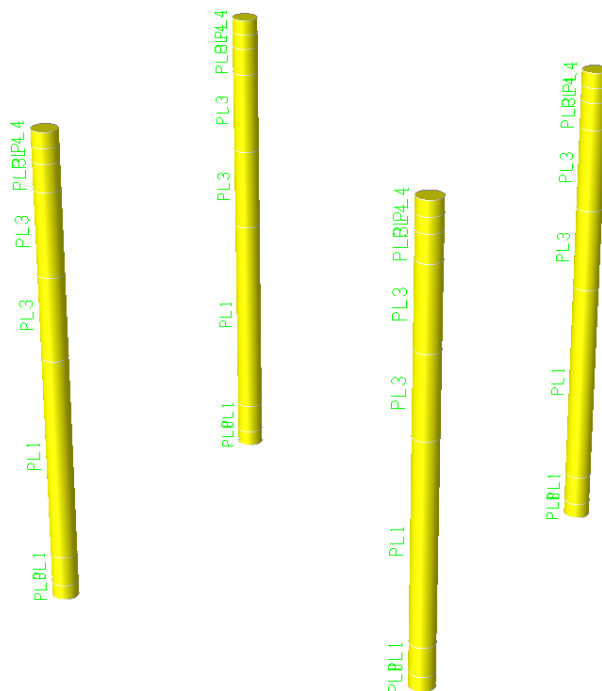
Pali di fondazioni emergenti dal terreno
